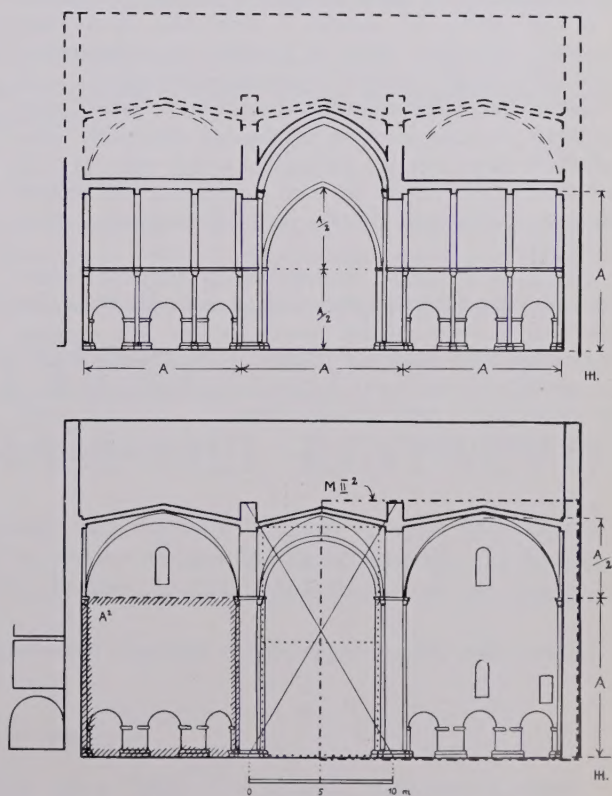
Eberbach I, in alto: schizzo ricostruttivo della sezione del transetto, dalla prima pianta della fig. 2; ed Eberbach II, in basso: sezione trasversale del transetto attuale, dalla seconda pianta della fig. 2
